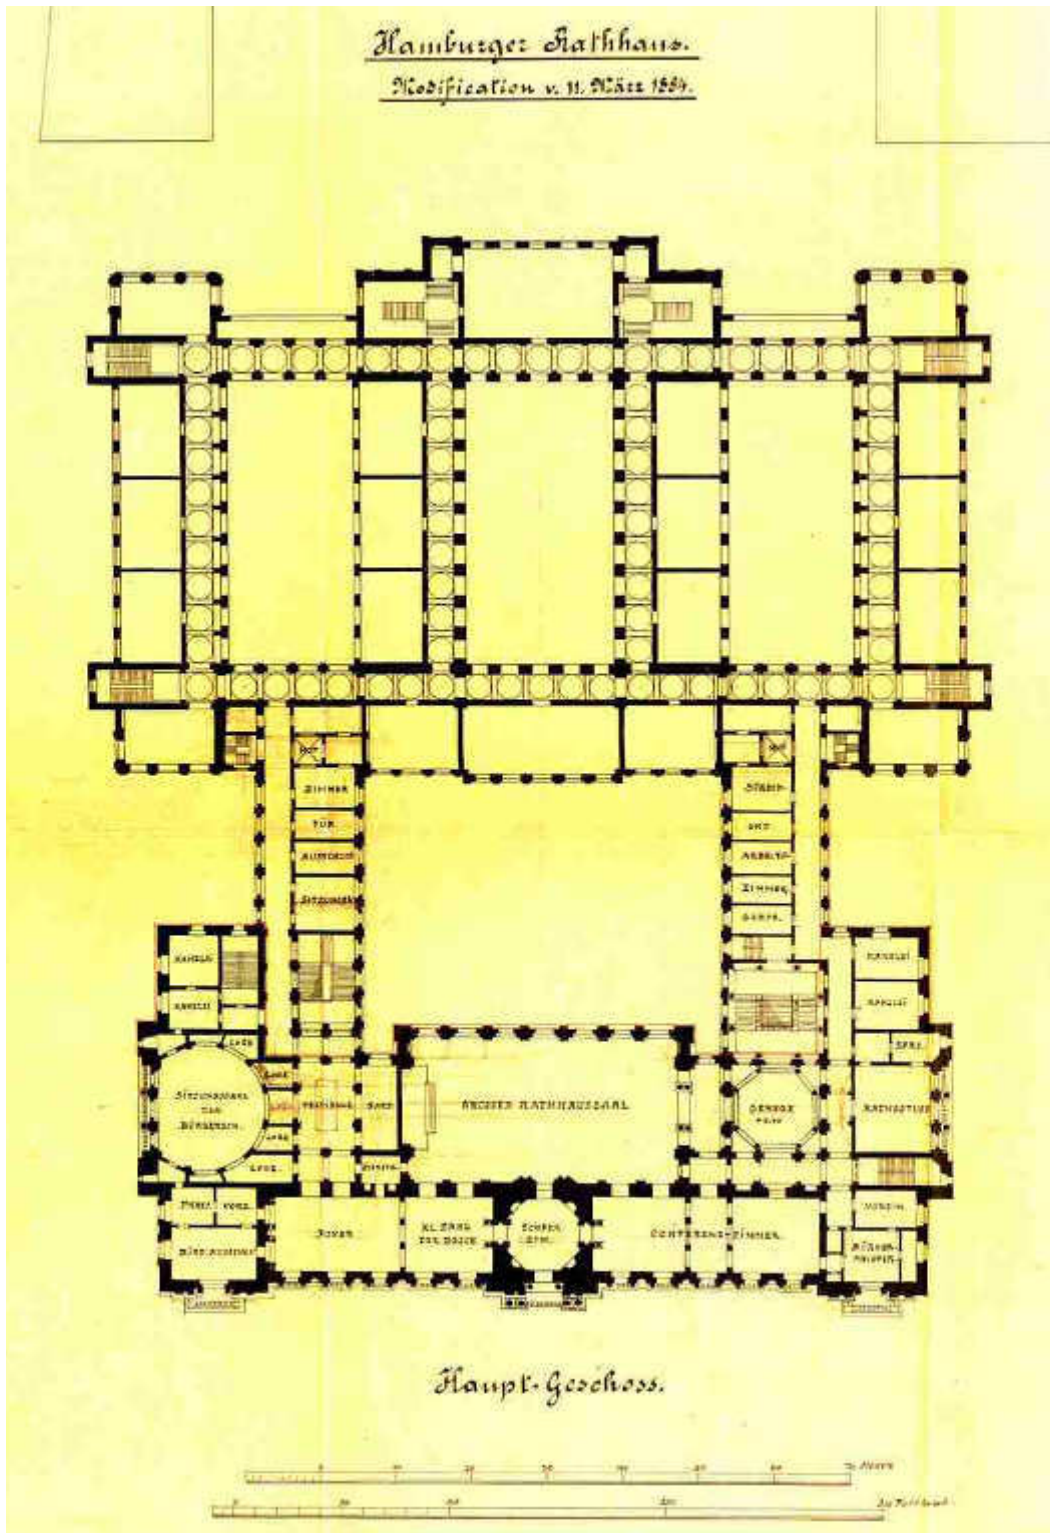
Grundriss Hauptgeschoss mit Börse vom 11. März 1884.
